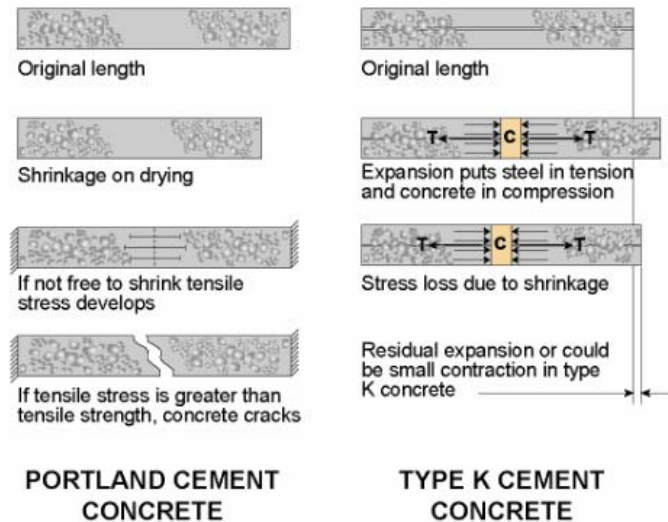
Muestra del comportamiento resistente de hormigones con cemento o aditivo tipo K a la fisuración por retracción plástica (Mehta y Monteiro, 2006)⁶².
